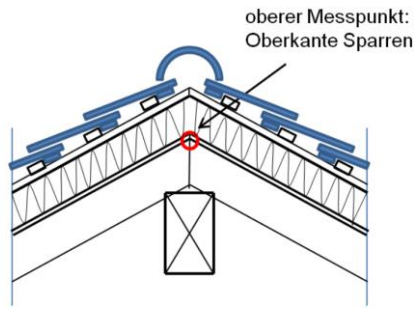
Dachquerschnitt. Alle Bauelemente oberhalb der Sparren (Dacheindeckung, Lattung/Konterlattung, Unterdach, ggf. Isolation oberhalb der Sparren) zählen nicht zur Dachkonstruktion (Quelle: Leitfaden zur Harmonisierung der Baubegriffe vom 1. März 2017)
